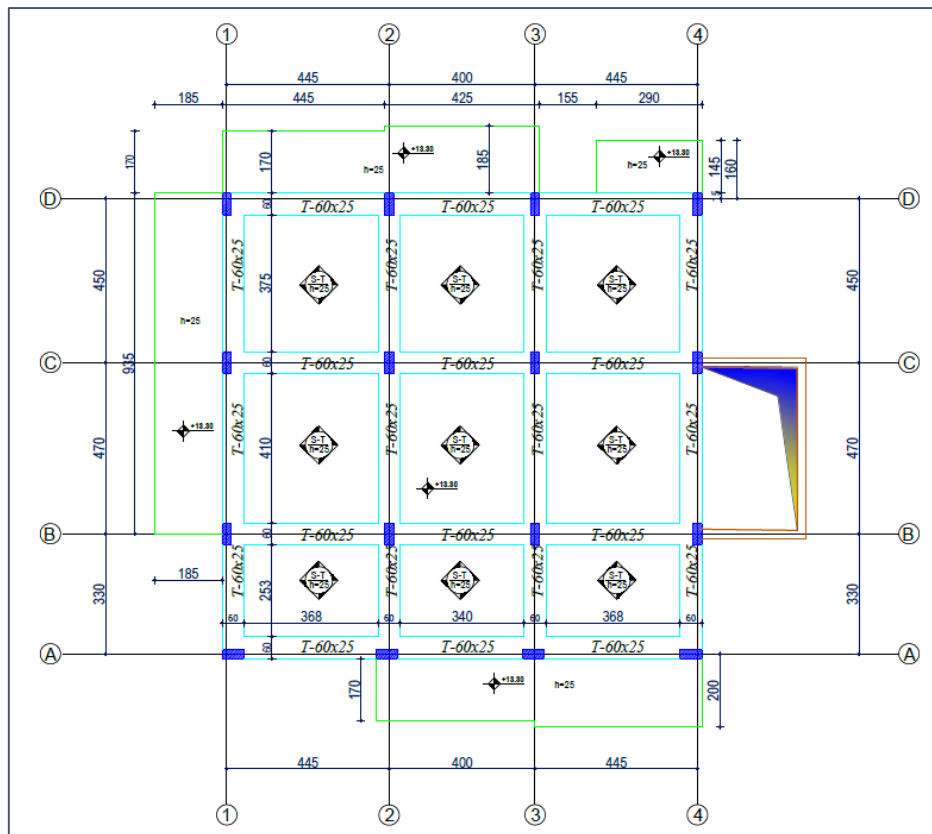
Plani i strukturave kuota +13.30 m, +16.45 m dhe +19.60 m (projekti i zbatimit)
